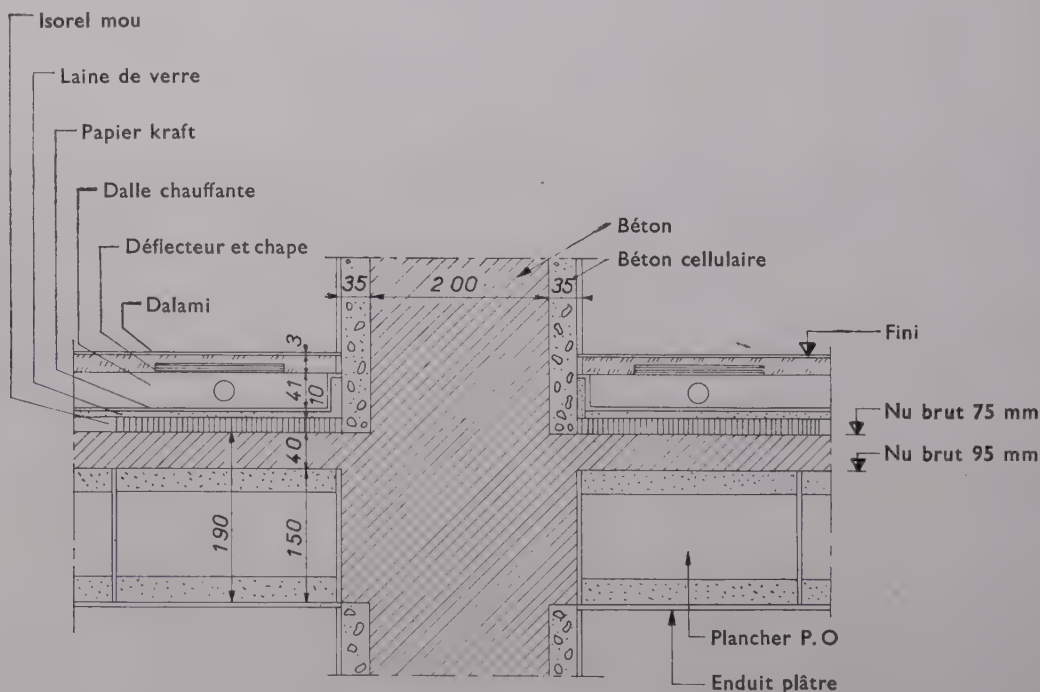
Coupes sur planchers (avec isolation phonique).
